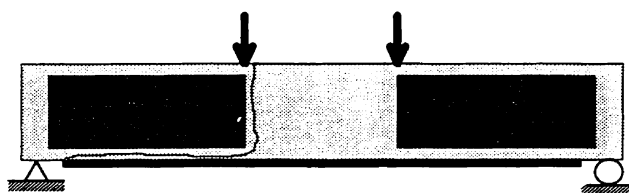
Collage de plaques sur les parois verticales de la poutre.
